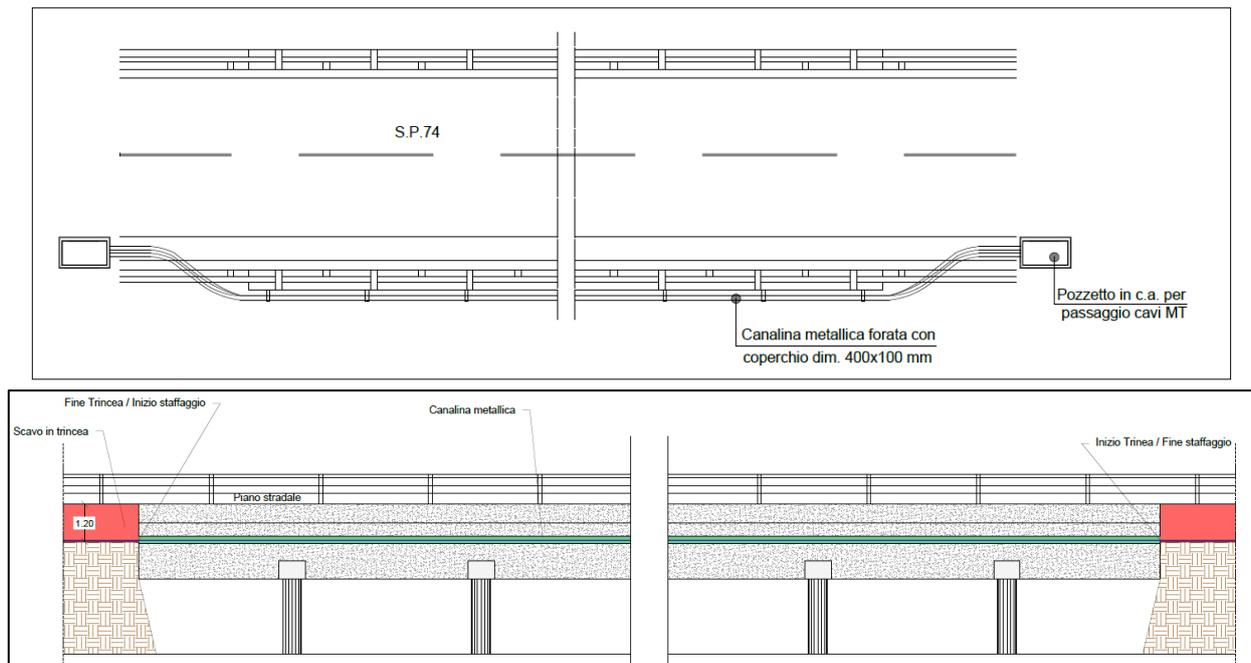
Planimetria e sezione tipologica attraversamento idraulico n.8
